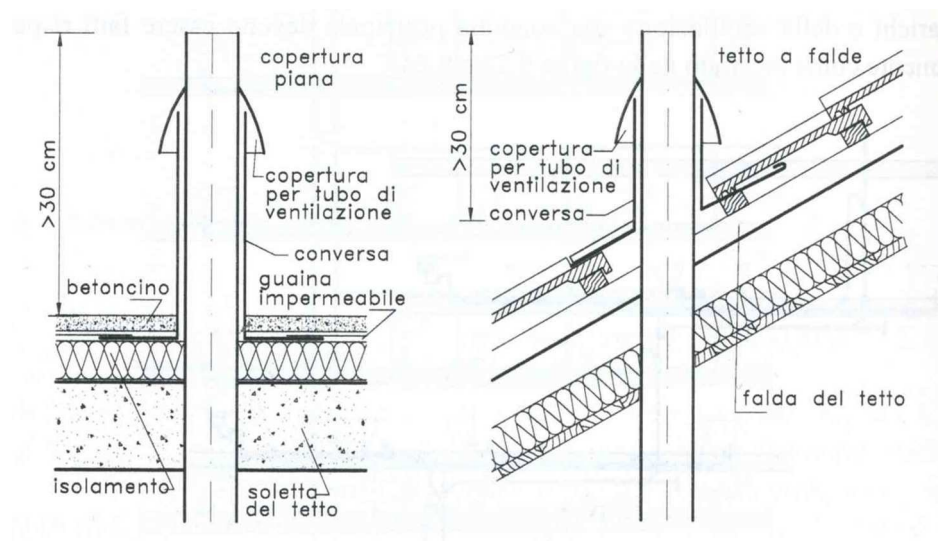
Particolare di attraversamento del tetto di colonne di ventilazione
